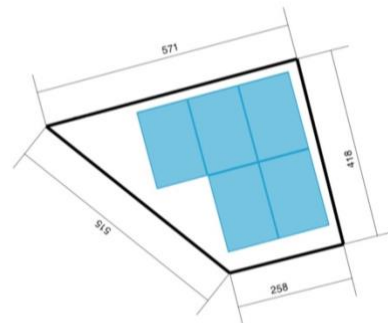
Lüttschbachstrasse 3, Belegungsplan, Dachfläche 3: südlicher Teil der östlichen Spitzgaube.
